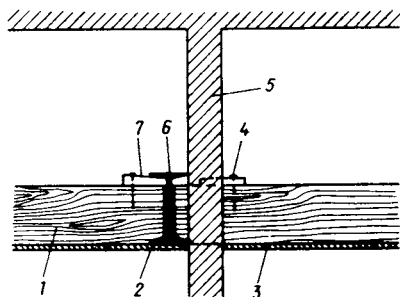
Укладка балки на поперечину (двухтавровая балка)
